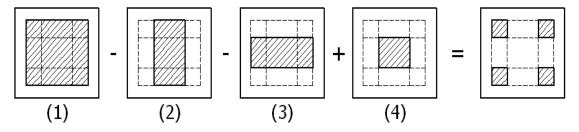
Schéma expliquant la concentration des charges sur la dalle
